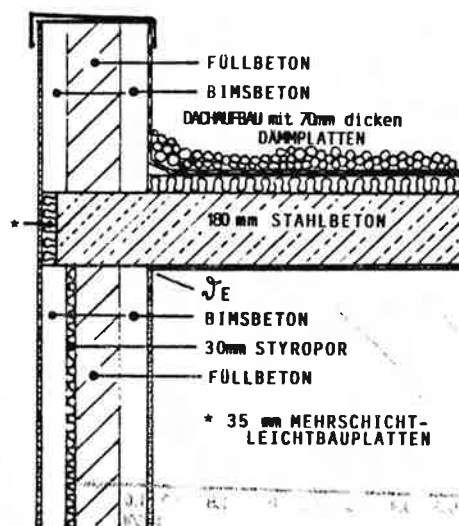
Dachrandausbildung mit Beton-Schalungssteinen
